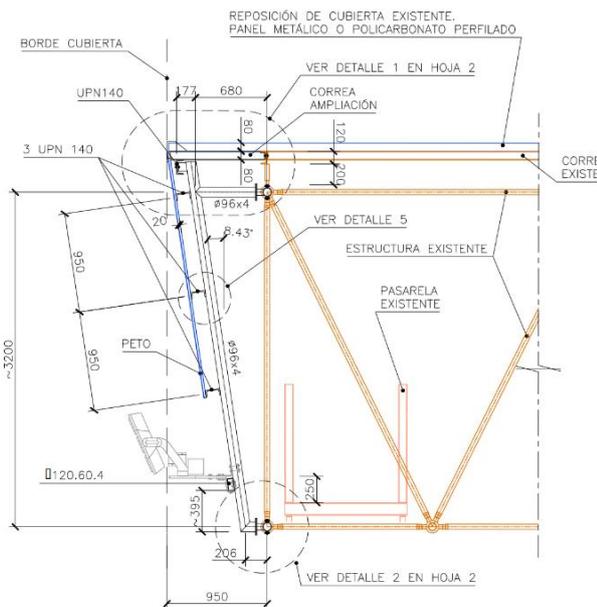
Vista lateral de la estructura de soporte del faldón interior en los fondos de Maratón y Pabellón, conectada a la estructura existente. Fuente: elaboración propia.
